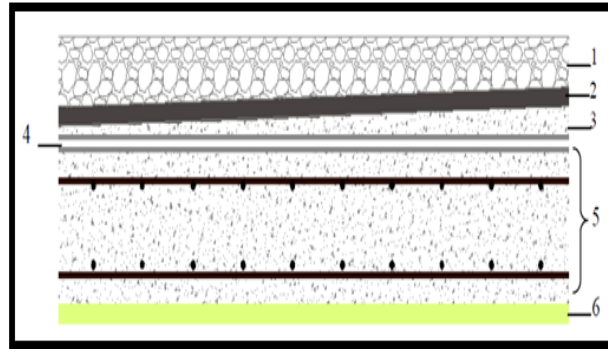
Composants d'un plancher terrasse en dalle pleine.
